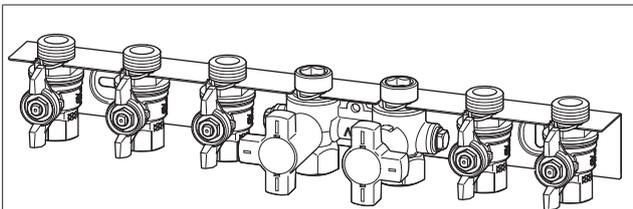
Kugelhahn-Anschlussset mit Flypass-Armatur
